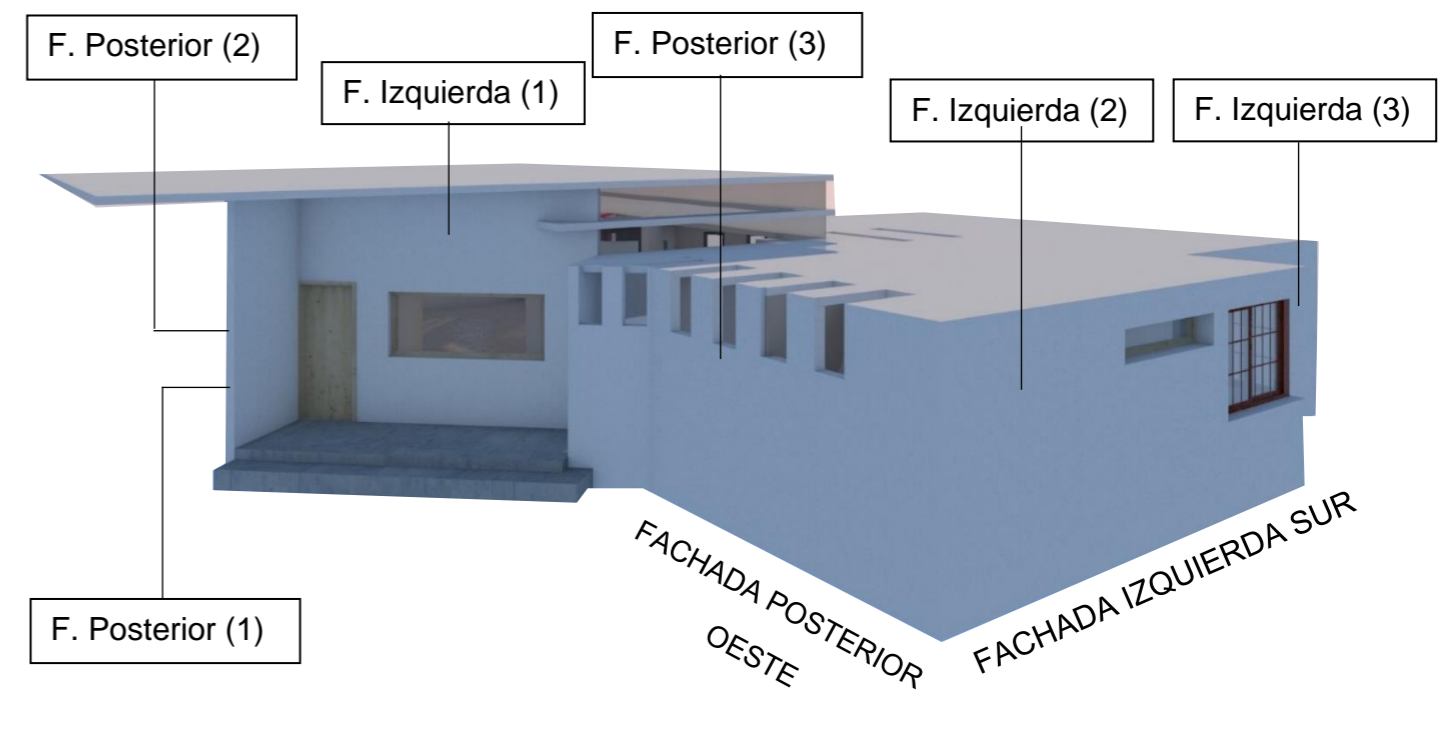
Ubicación de muros en fachada posterior oeste y fachada sur izquierda (propia, Elaboración)
